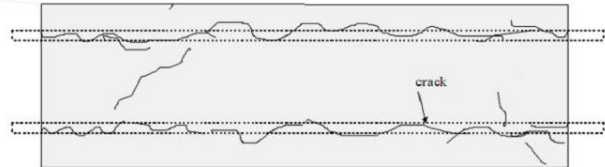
Тріщини на поверхні бетонних плит в експерименті Лю / Cracks in the surface of the concrete slabs in the experiment Liu
